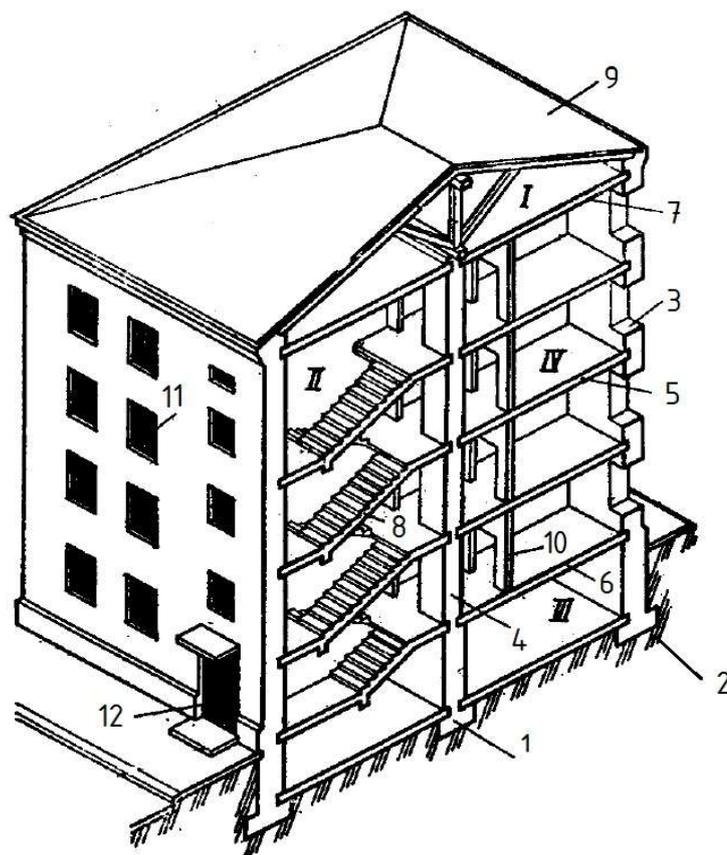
Основные конструктивные элементы здания: 1– фундамент; 2 - основание; 3 – наружная стена; 4 – внутренняя стена; 5 - междуэтажное перекрытие; 6 - надподвальное перекрытие; 7 – чердачное перекрытие; 8 – лестничная клетка с маршем; 9 – крыша; 10 – перегородка; 11 – окно; 12 – дверь.
